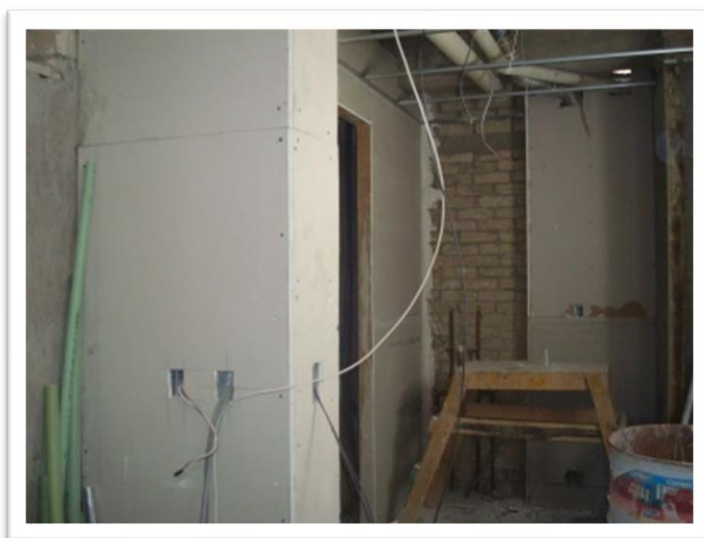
Muro de tablaroca @ 40.5 cm poste estructural de 1.20 m hasta 2.8 m de altura en área de lavadora lambrin de durock @ 40.5 cm poste estructural hasta 1.2 m de altura para ocultar instalaciones por cambio de proyecto (verticales). Autoría propia (2011)
